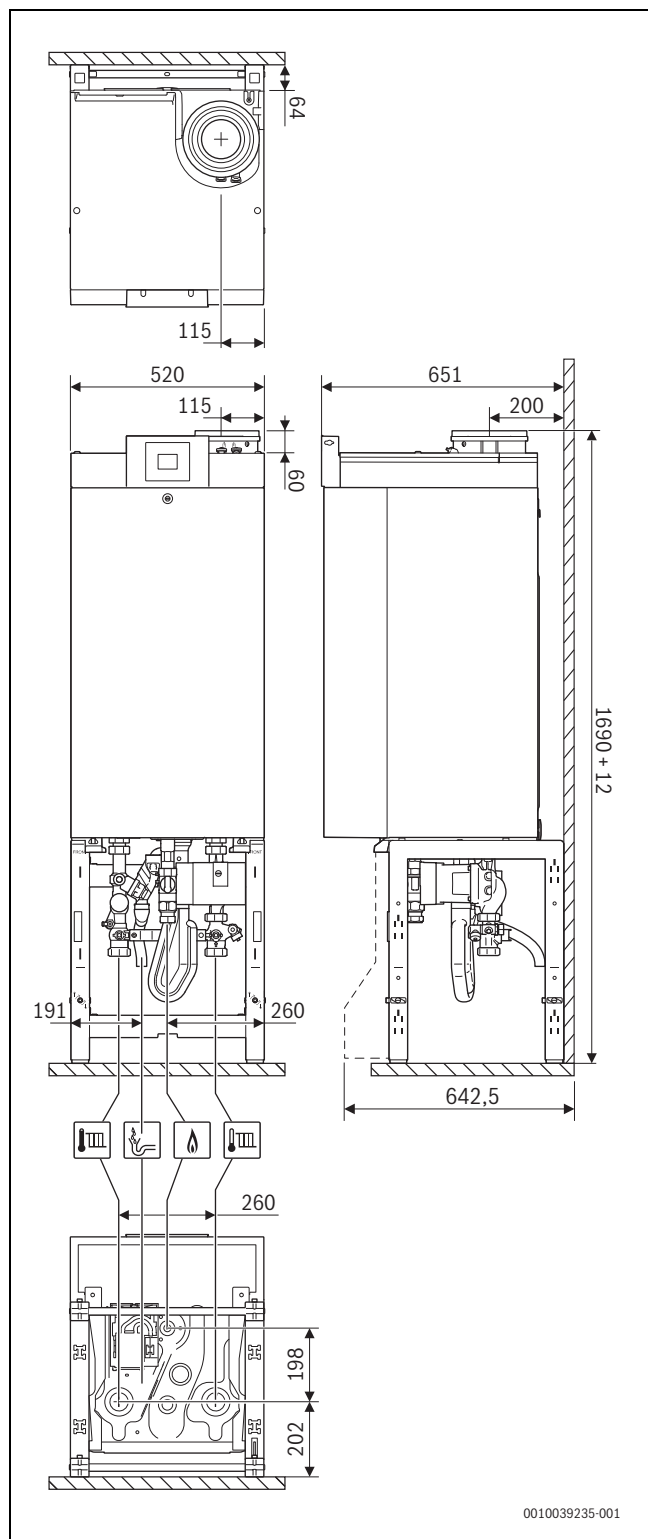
Dimensiuni pe cadrul de bază [mm]
